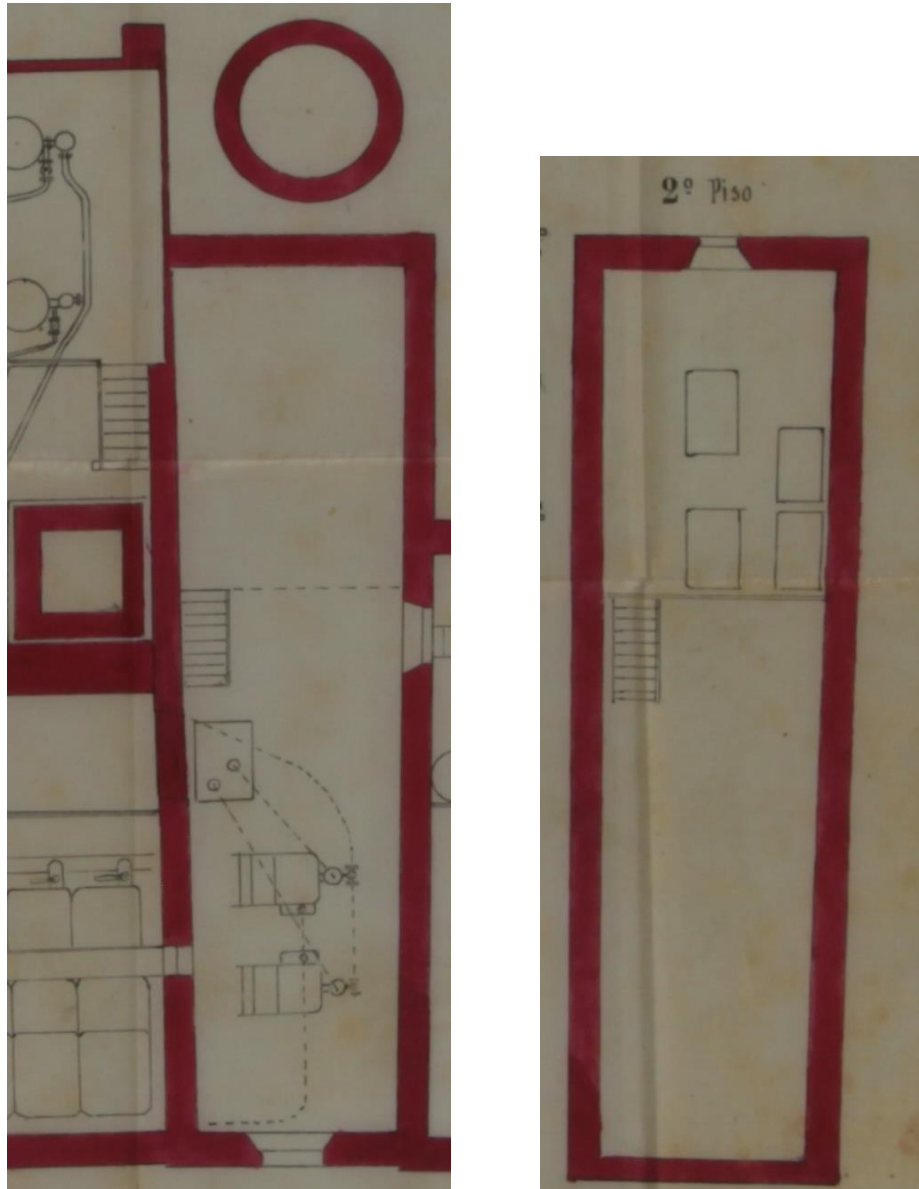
Planta baja, con chimenea al fondo y segundo piso de la nave de depuración. Archivo de Torres Cabrera.
